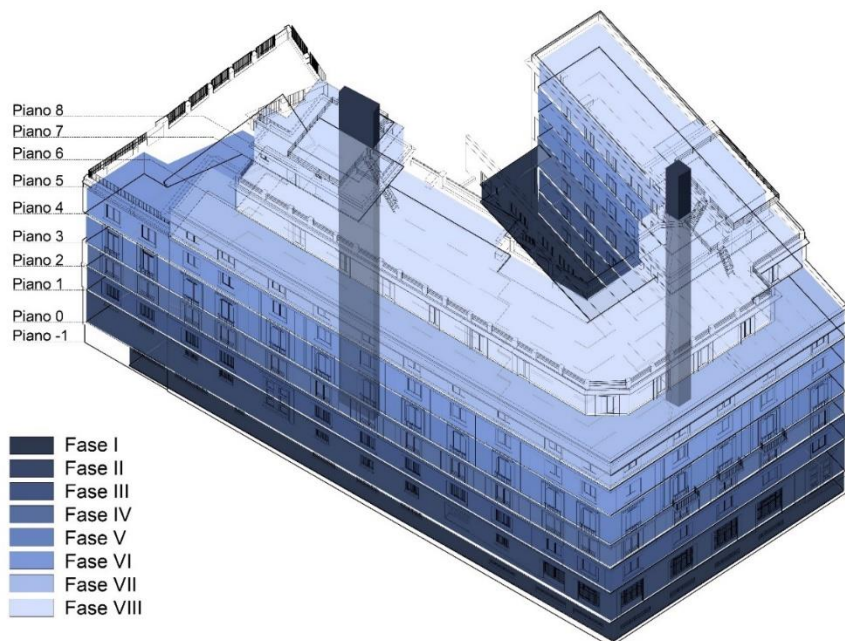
Soluzione 1 – Compartimentazione orizzontale - Vista assometrica
